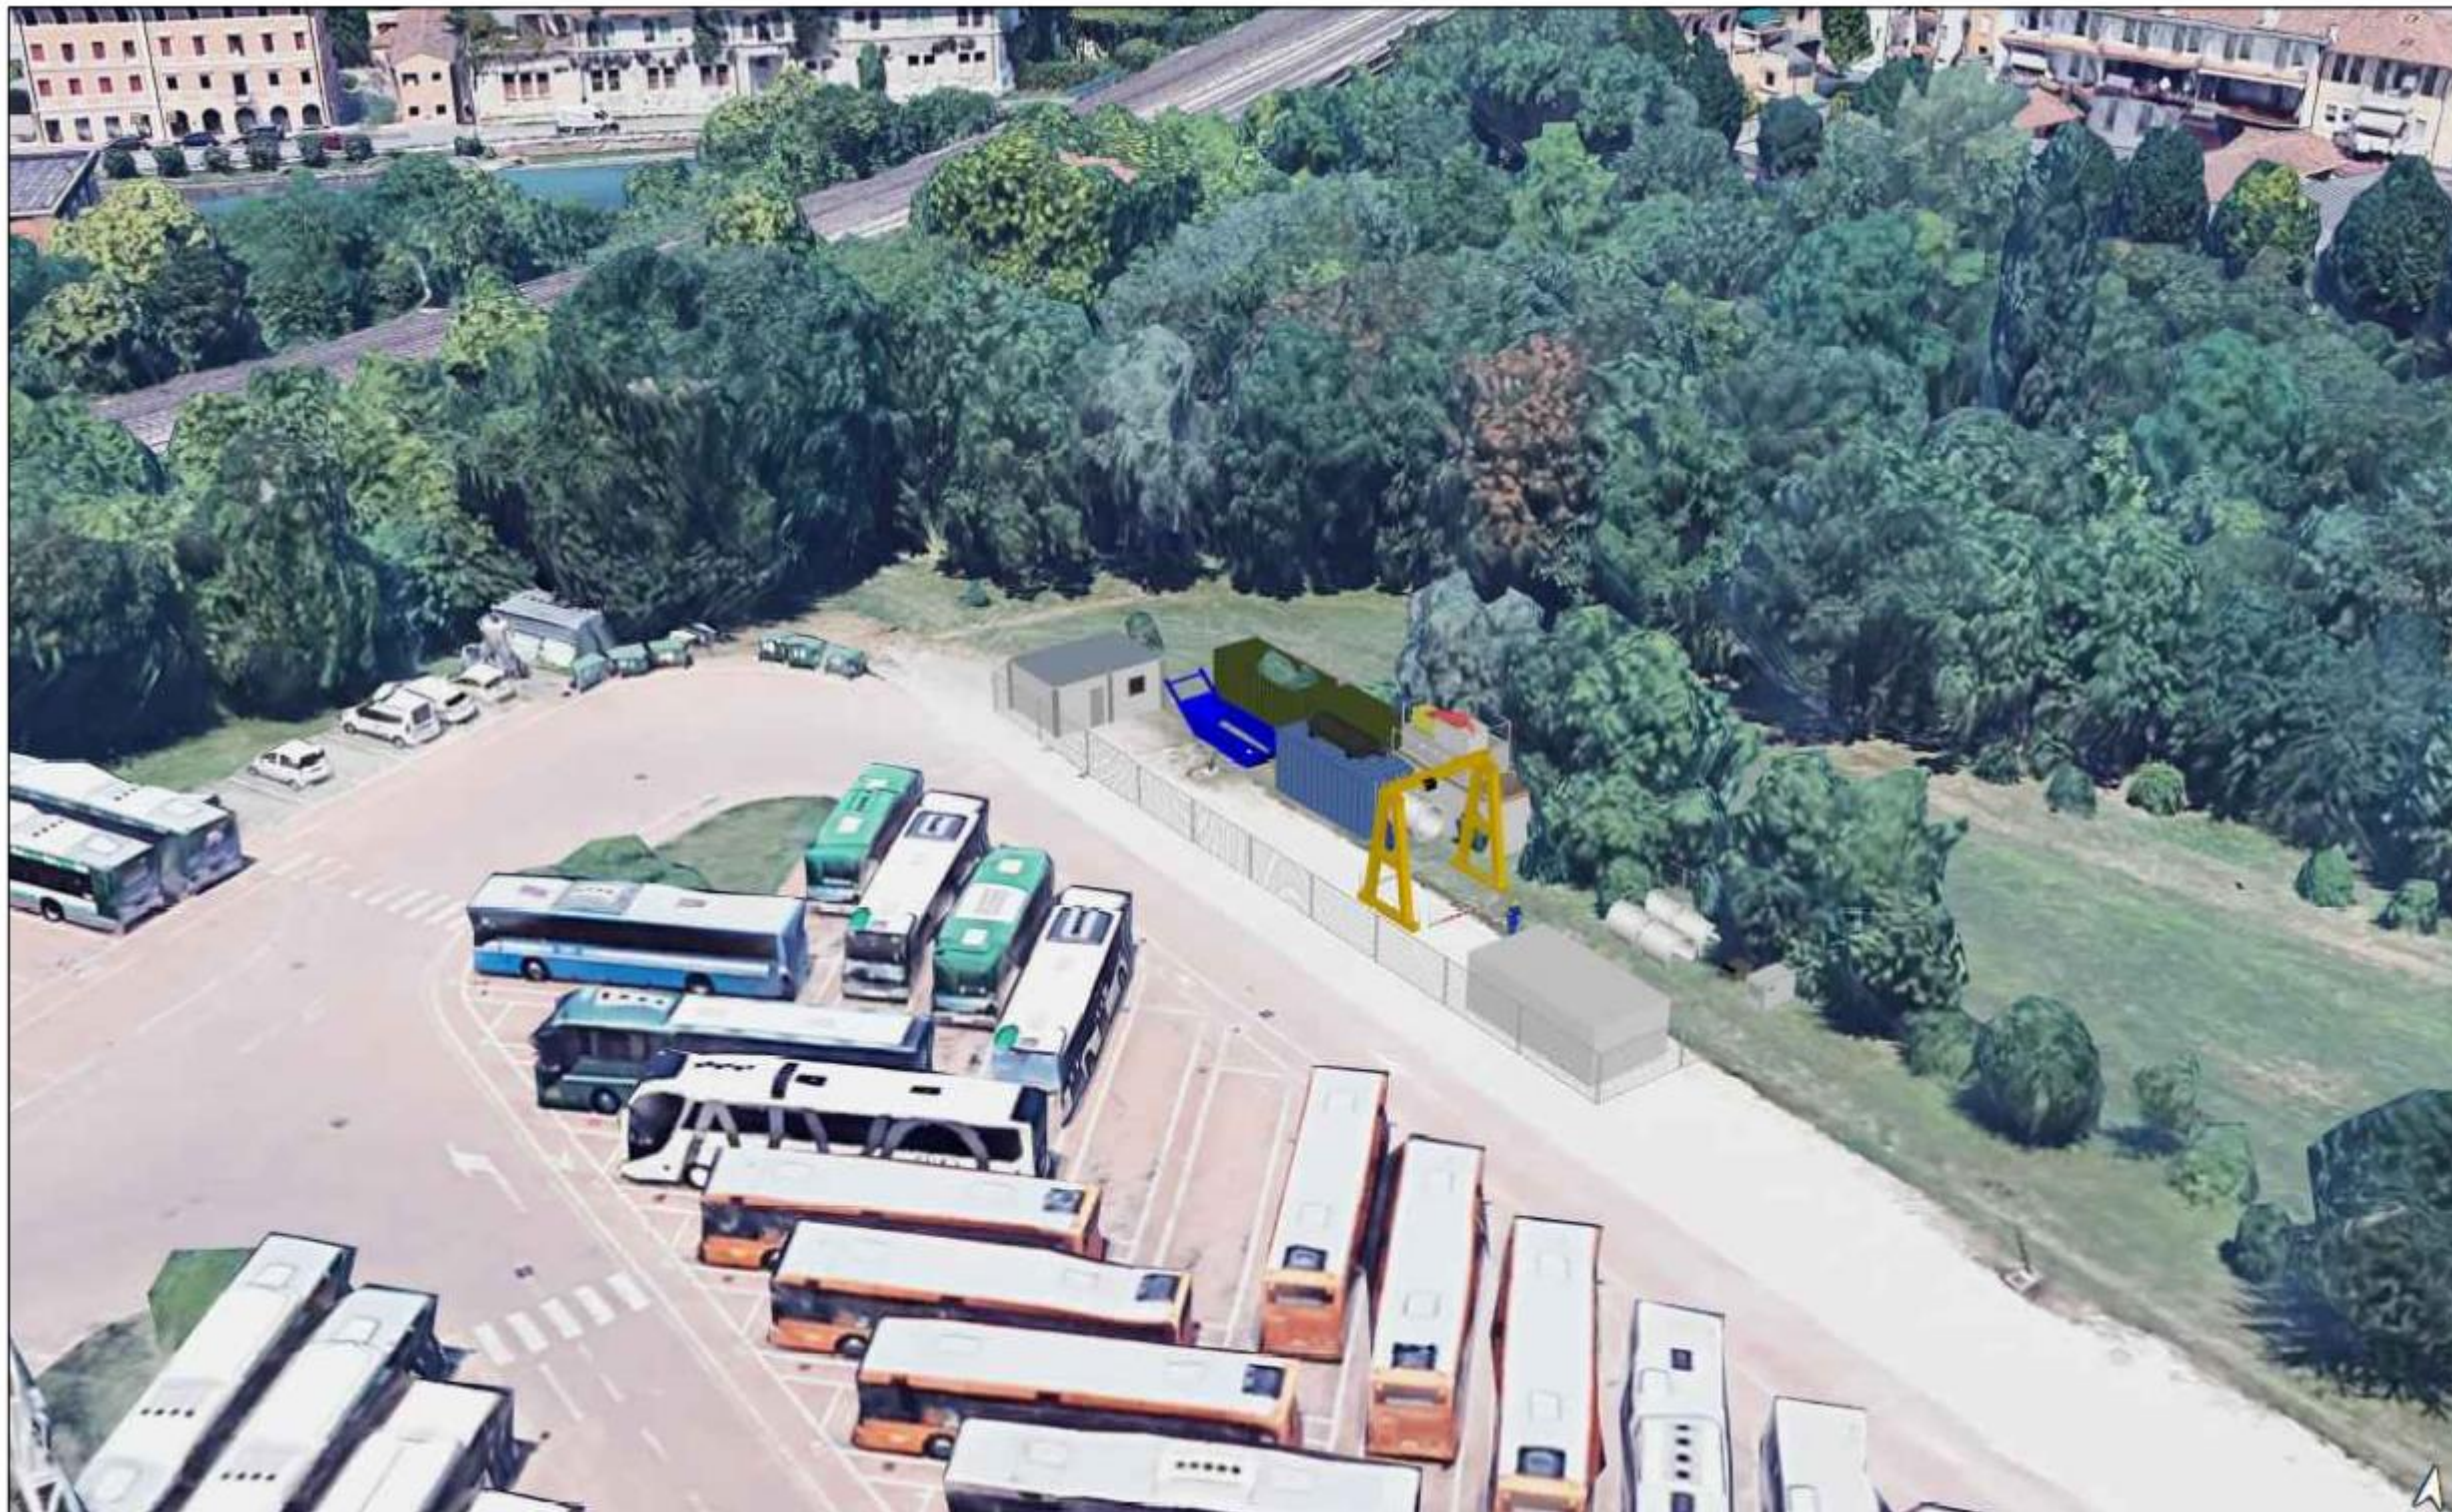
N : Foto inserimento vista area cantiere POZZO S02a
